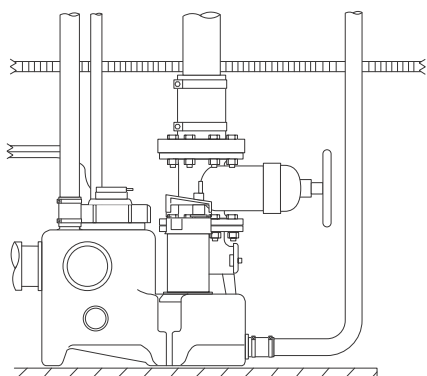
Robinet d'arrêt sur le haut du clapet anti-retour
